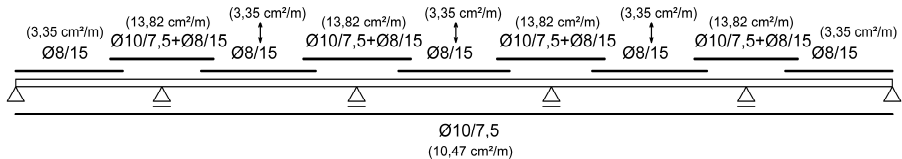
Bewehrungsskizze der erforderlichen Bewehrung zur Begrenzung der Rissbreite bei Überlagerung der Beanspruchungen infolge von Zwang und äußerer Last
